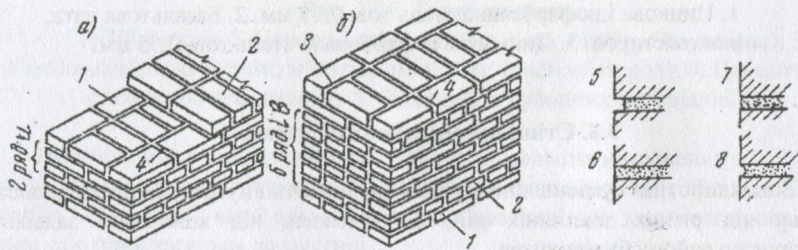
Система перев'язування і оброблення швів цегляної кладки: а – ланцюгова; б – п'ятирядна; 1 – довжник; 2 – поперечик; 3 – повздовжній шов; 4 – поперечний шов; 5 – кладка упустошовку; 6 – впідріз; 7, 8 – під розшивку.
